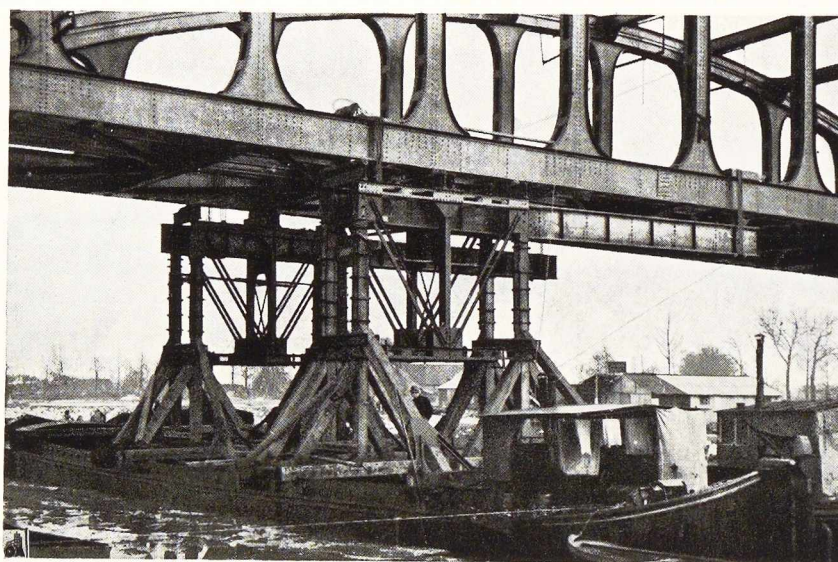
Palée flottante utilisée pour le lancement des ponts Vierendeel sur le canal Albert.
